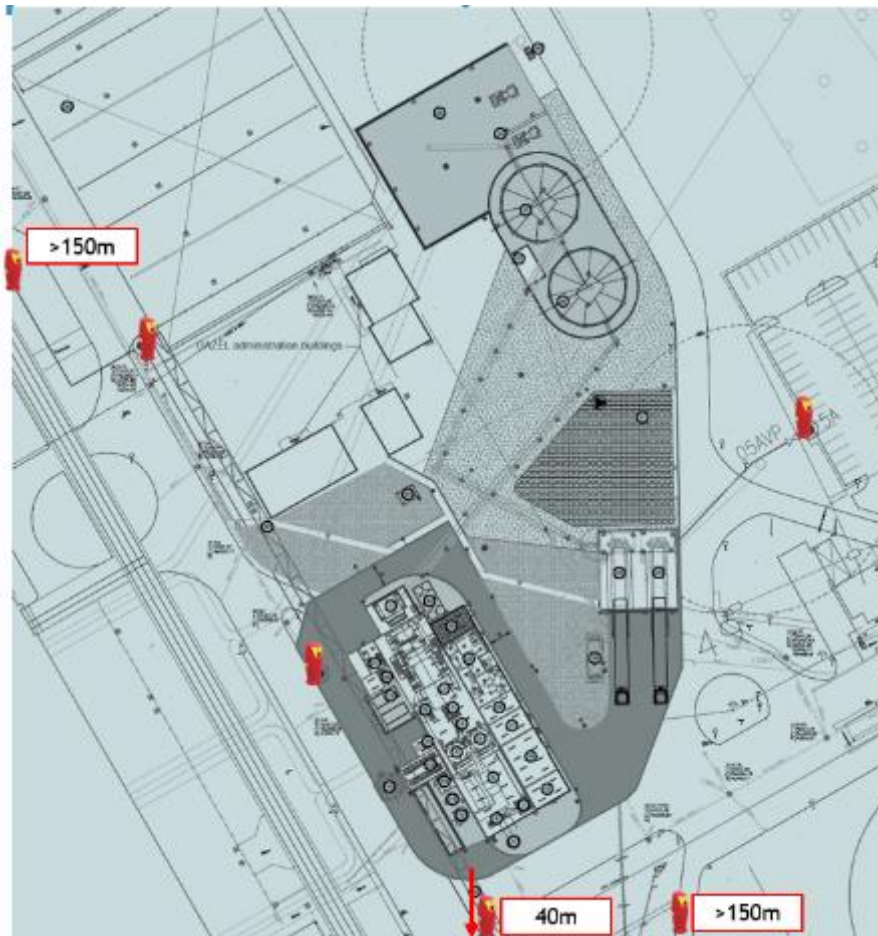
implantation des poteaux incendie sur le site de la chaufferie EHB
